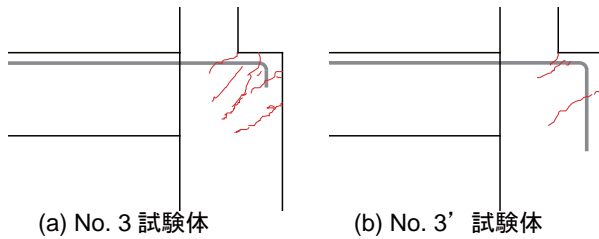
接合部出隅付近のひび割れ状況(No. 3, No. 3')
